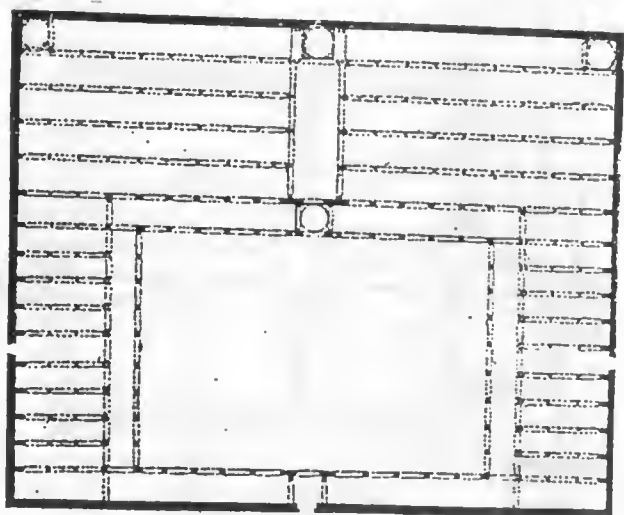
المسقط الأفقي لمشهد السيدة بنت أحمد عن
